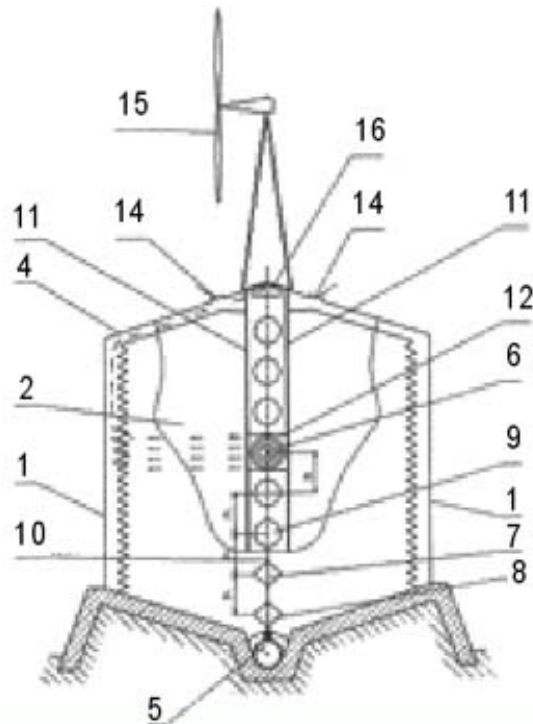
Загальний вигляд зерносховища-сушарки
